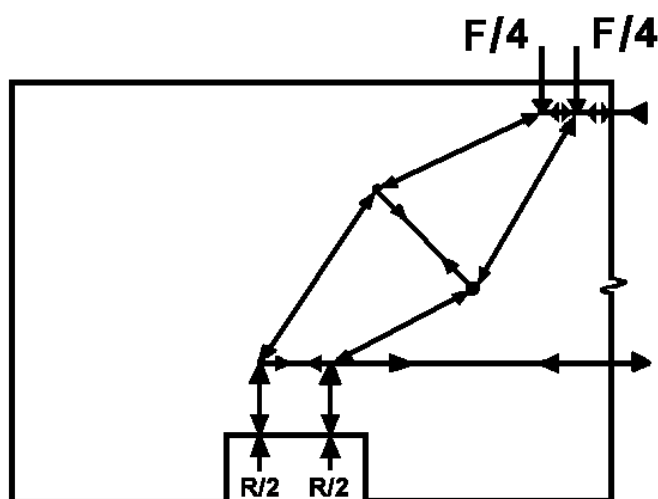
Modelo refinado de bielas e tirantes (ADEBAR et al., 1990)
